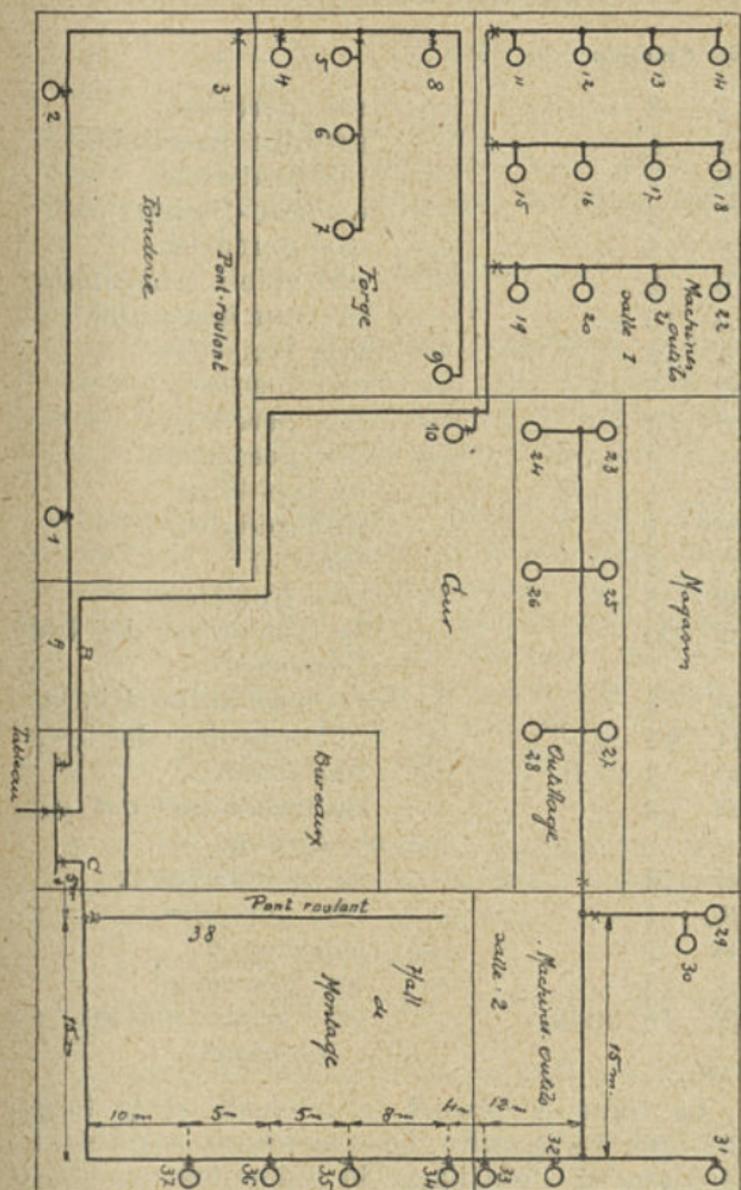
Installation d'un atelier de grosse construction mécanique sur secteur continu trois fils.
